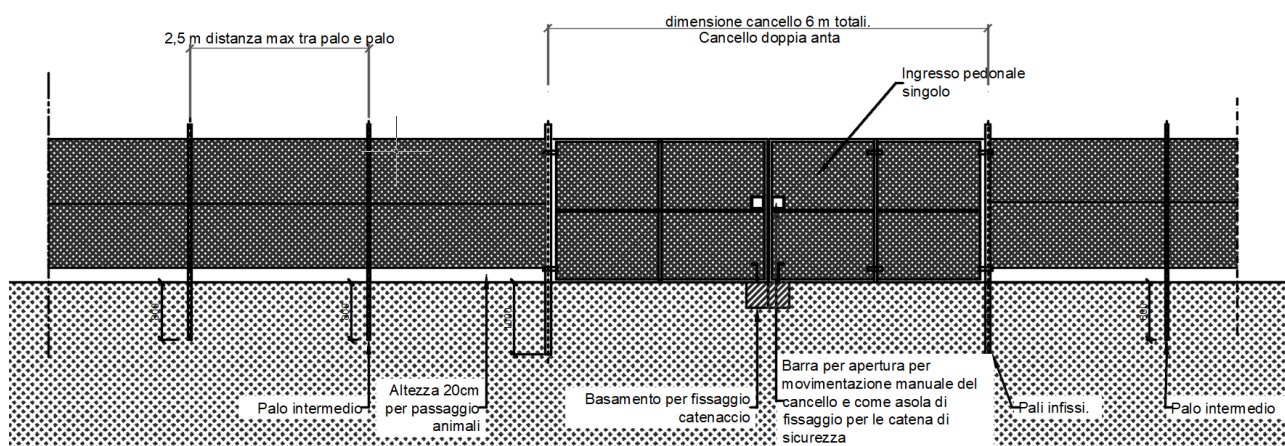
Dettaglio d'insieme della recinzione perimetrale con cancello di accesso all'area di impianto
